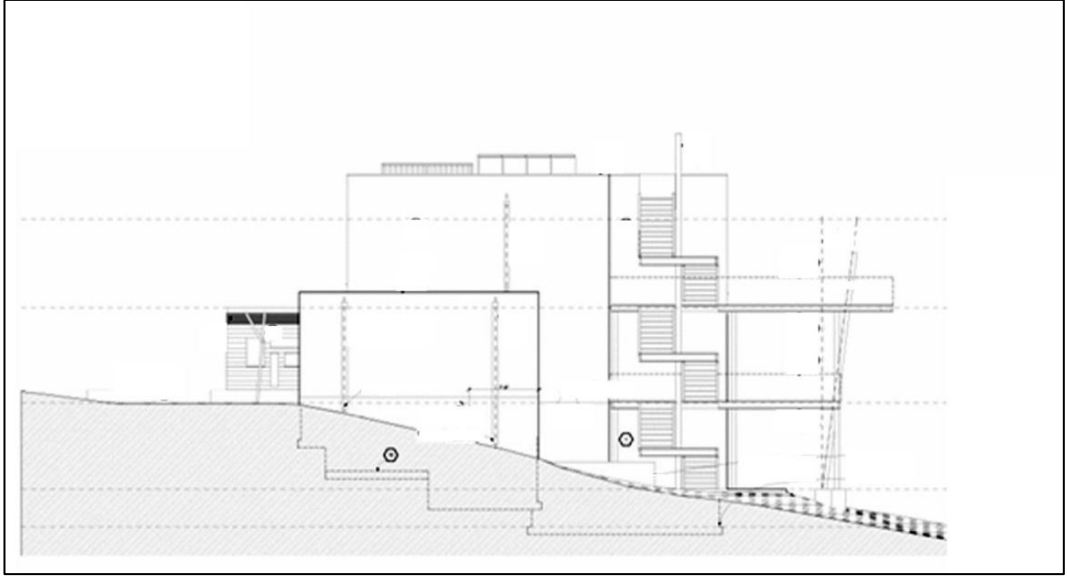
Sistem kesiti (Passive House In The Woods, bt)
